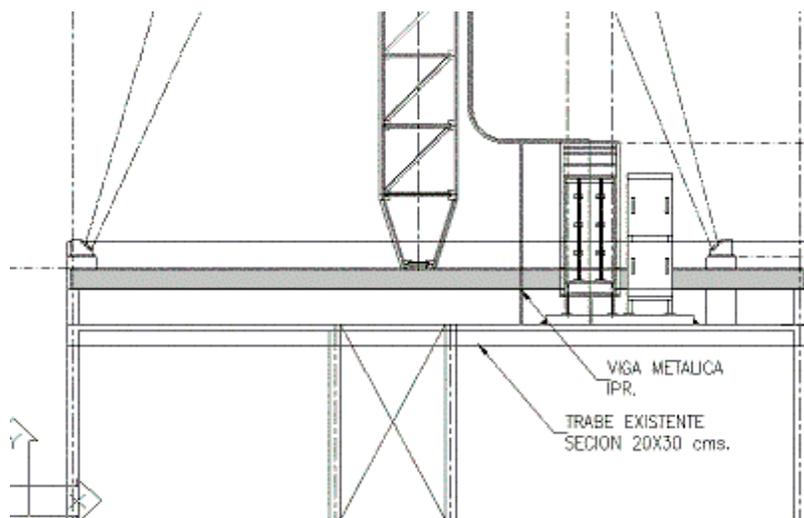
MODELO DE TORRE SOBRE VIGA METALICA
